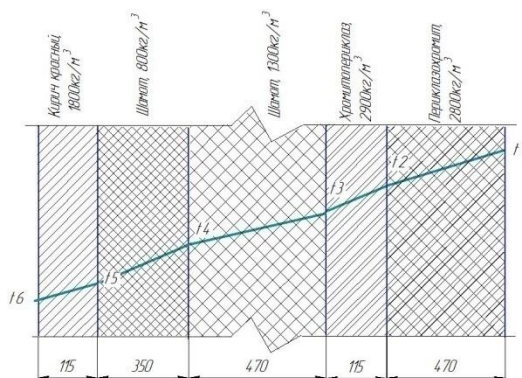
Разрез футеровки стены на 32–37позициях
